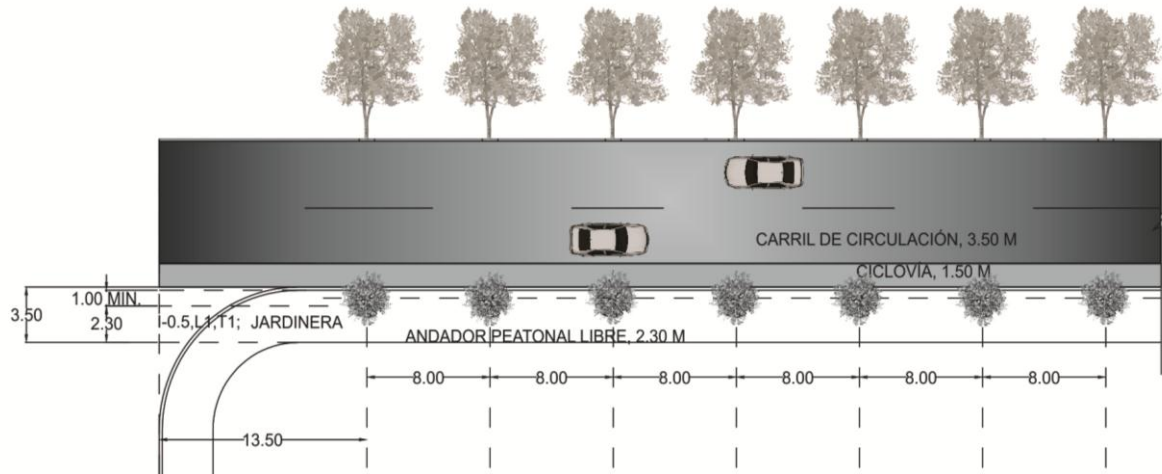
Planta de ejemplo para disposición elementos en el espacio público.
